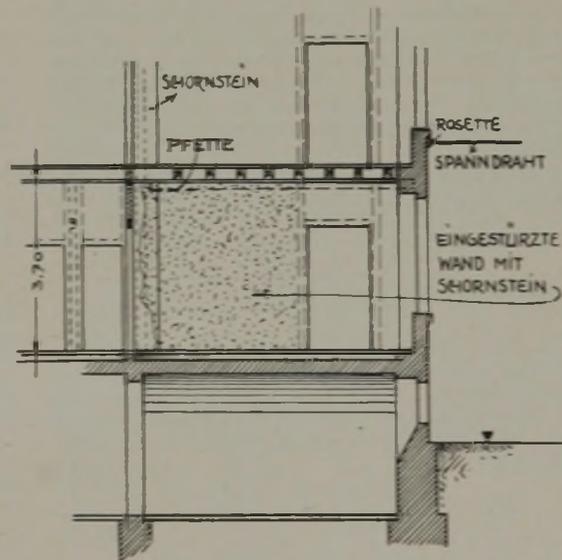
Lageplan zur Einrichtung in der Westendstr. 11. Abb. 6. Konstruktion der Einsturzstelle.
